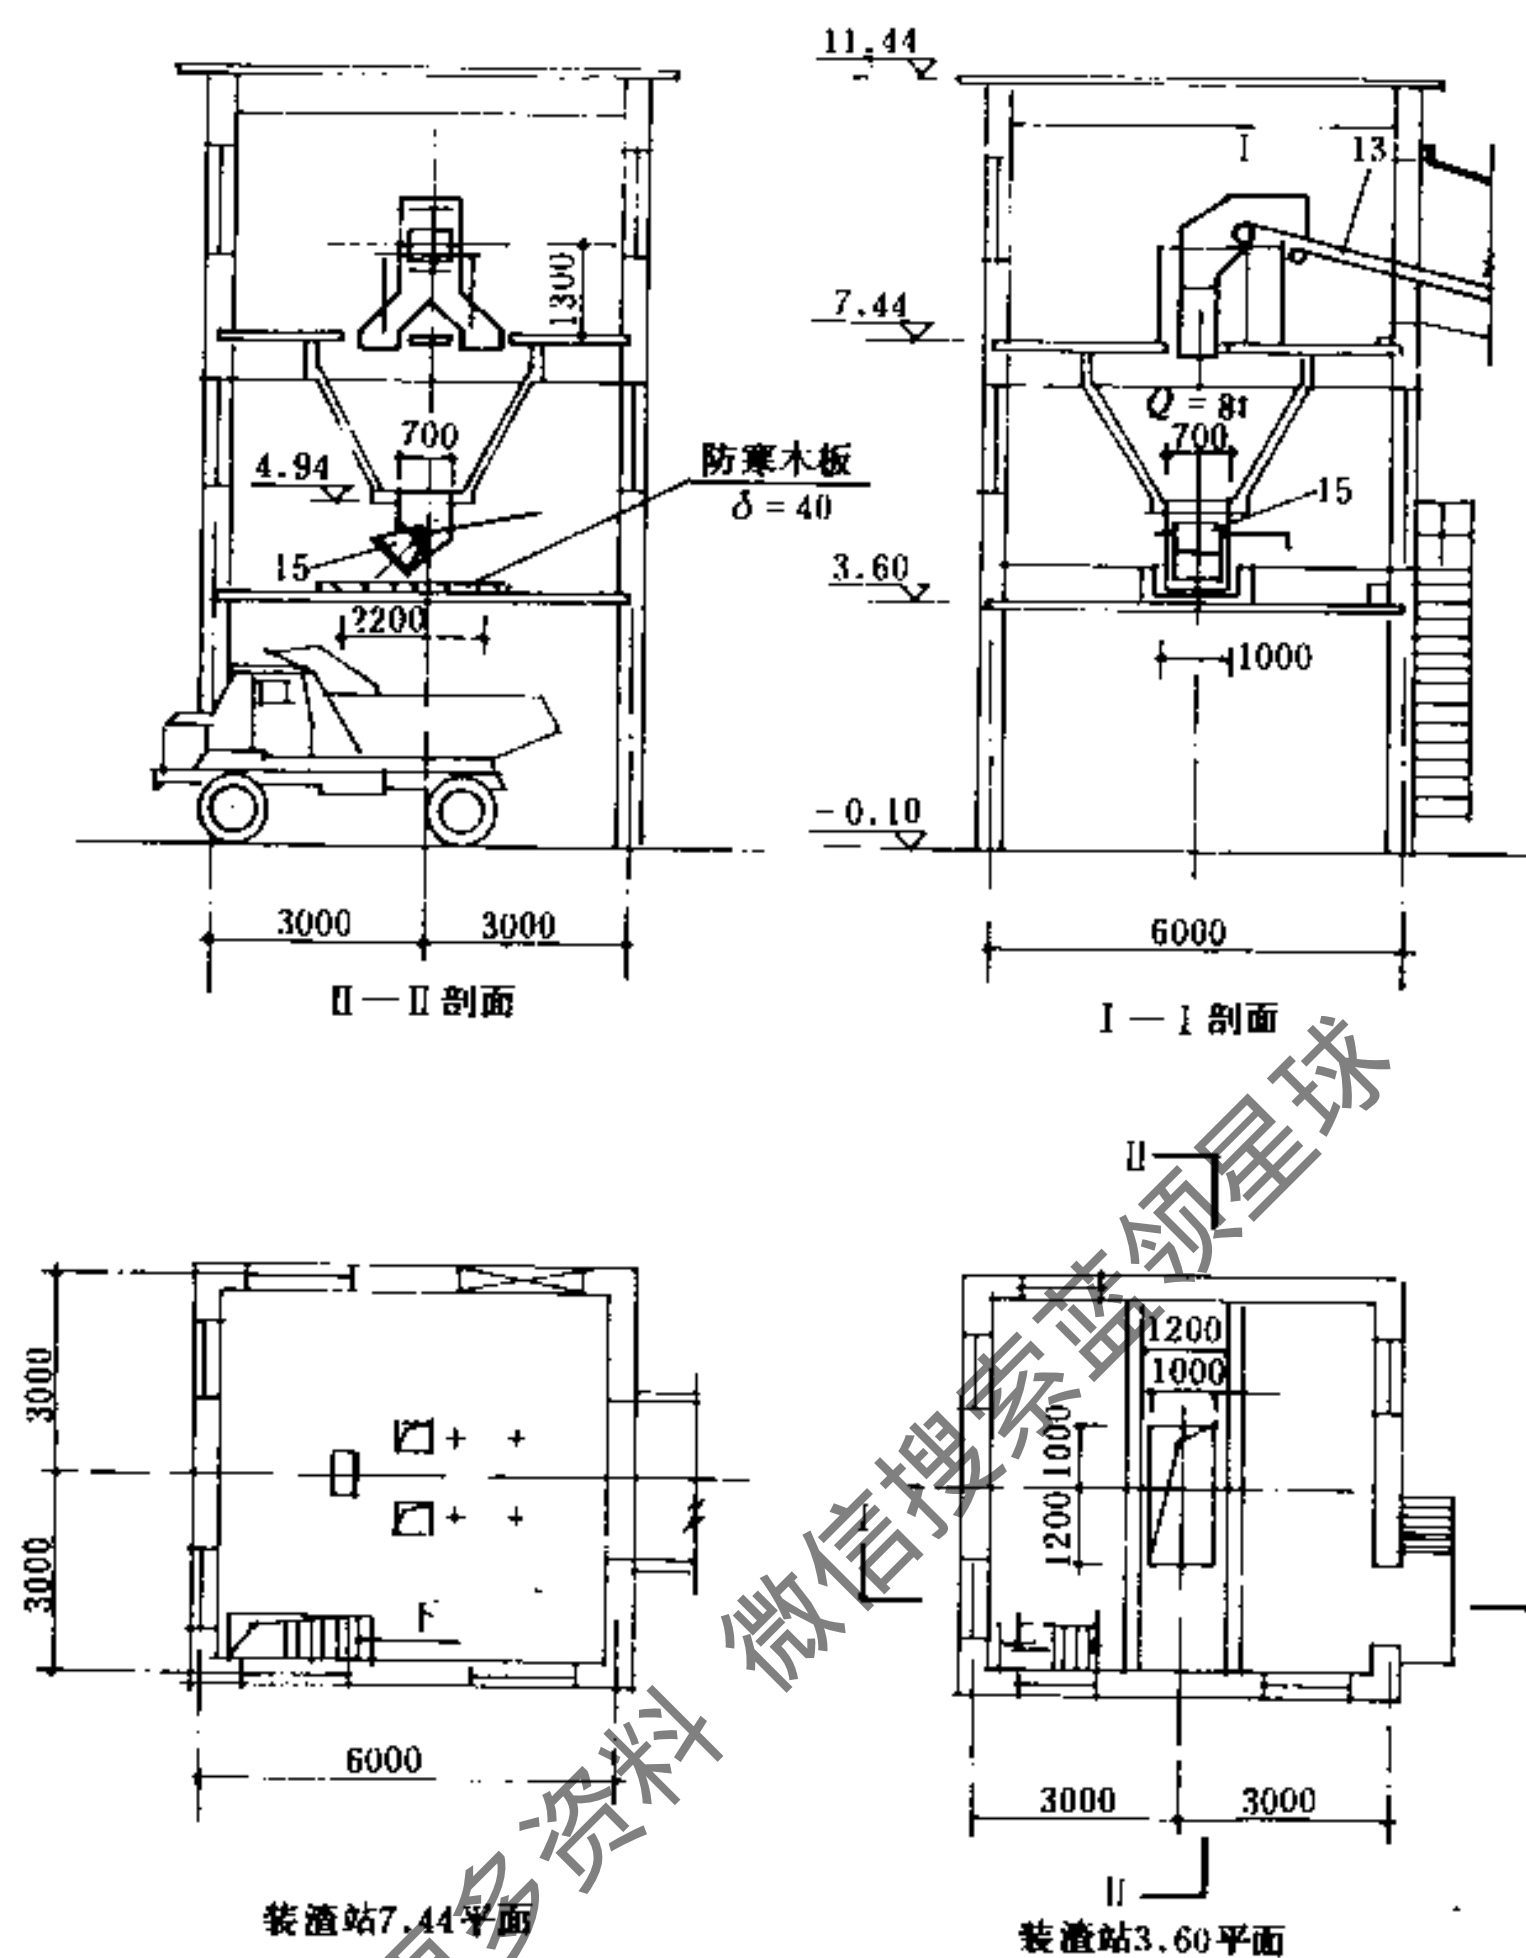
三台SHL-10-13A 型锅炉房装渣站平面图及剖面图
